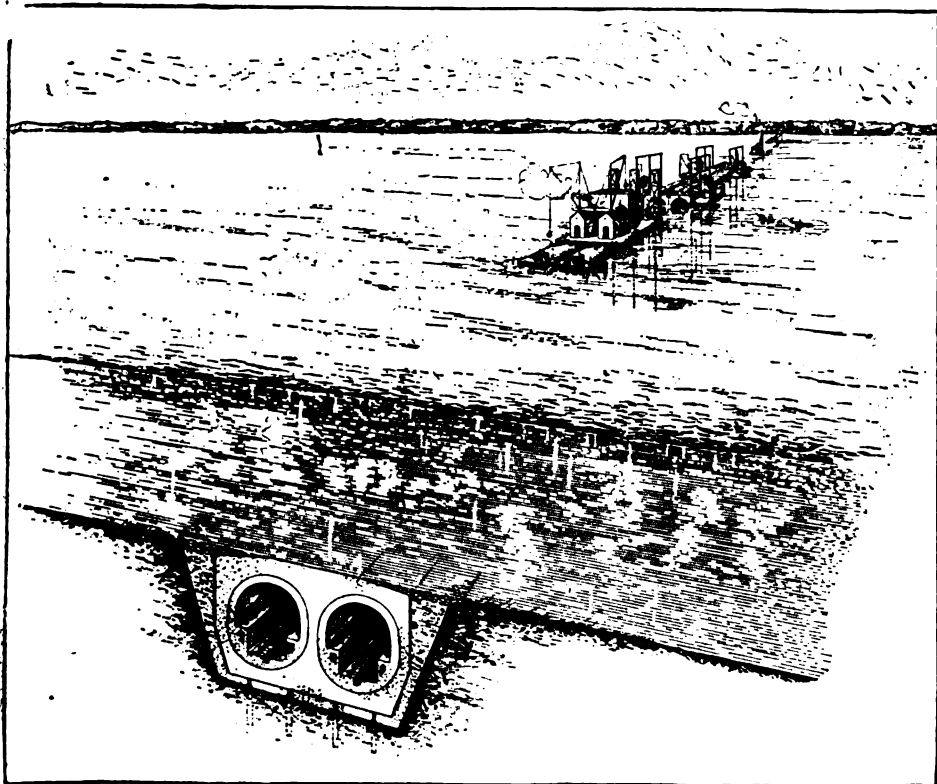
Tunnel sotto il Detroit River - Vista prospettica.
